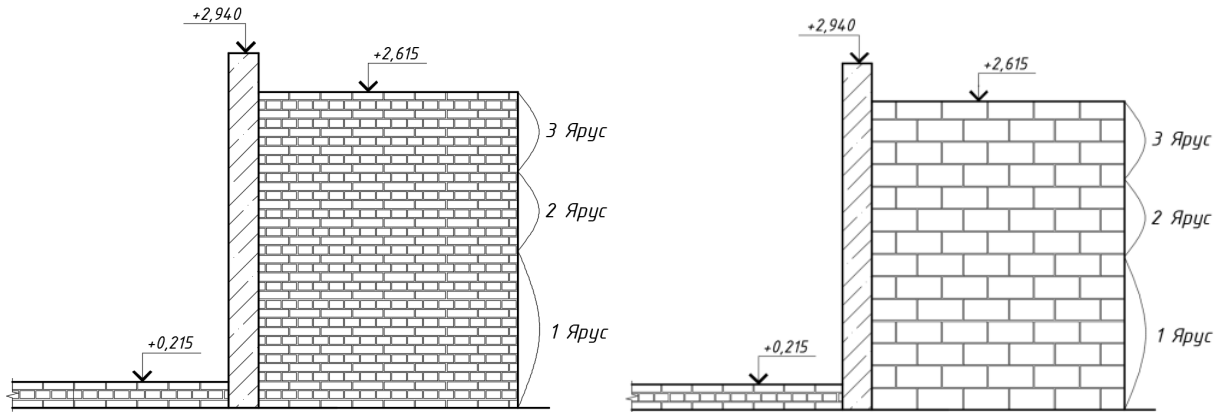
Фрагмент стены для 1-3 сравниваемые варианты возведения стены
